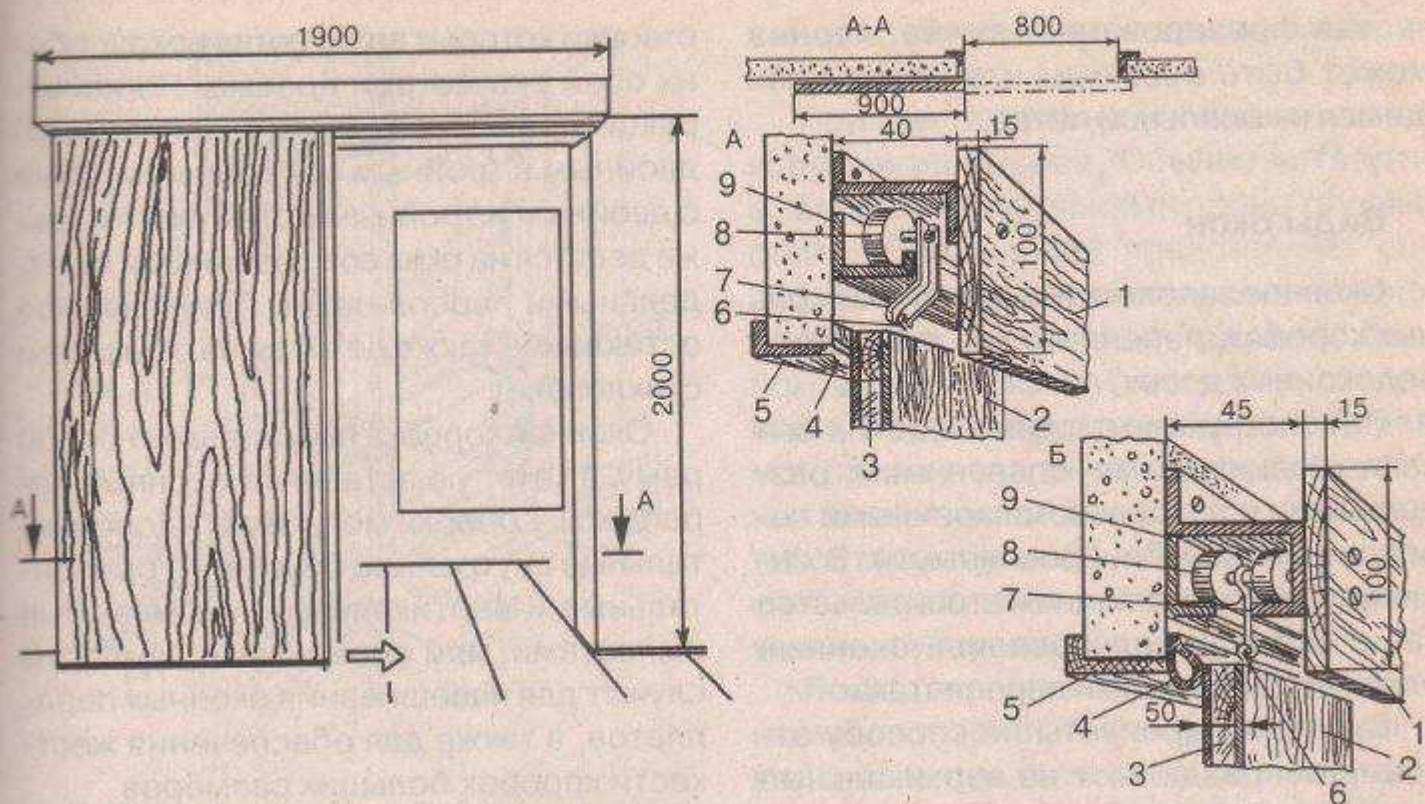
Одностворчатая раздвижная дверь на верхней подвеске: А — на однороликовых тележках; Б — на двухроликовых тележках; 1 — декоративные доски; 2 — двери; 3 — бруски каркаса; 4 — валики-уплотнители; 5 — облицовка притолоки; 6 — крючки подвески; 7 — держатели; 8 — ролики; 9 — кронштейны-направляющие
